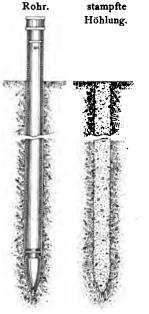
Herstellung eines Beton-Stampfpfahls in weichem Boden.
